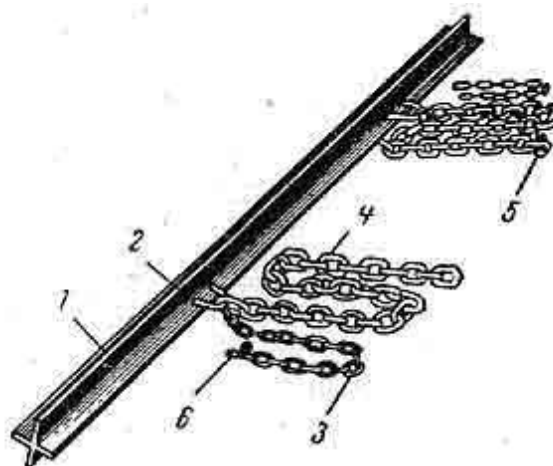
Горный рельс. 1 - балка, 2 - серьга, 3 - удерживающая цепь, 4 - натяжная цепь, 5 и 6 - болты.
